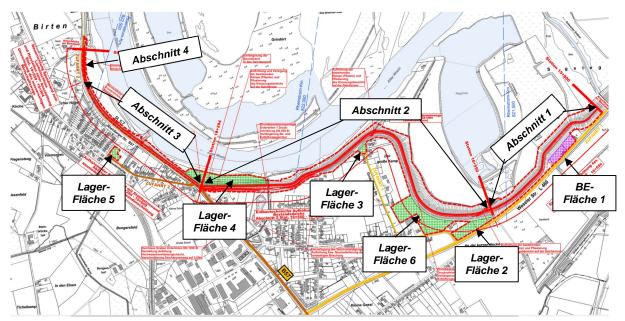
Bauabschnitte und Baufeld mit vorgesehenen Baustelleneinrichtungs- (BE-) und Lagerflächen
